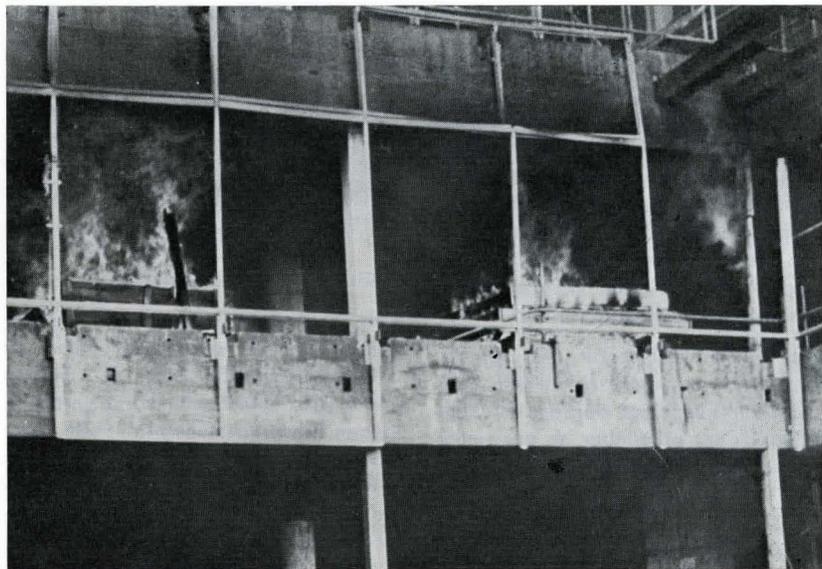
Abfallen der Fassadenelemente bei Hochhausbrand.
